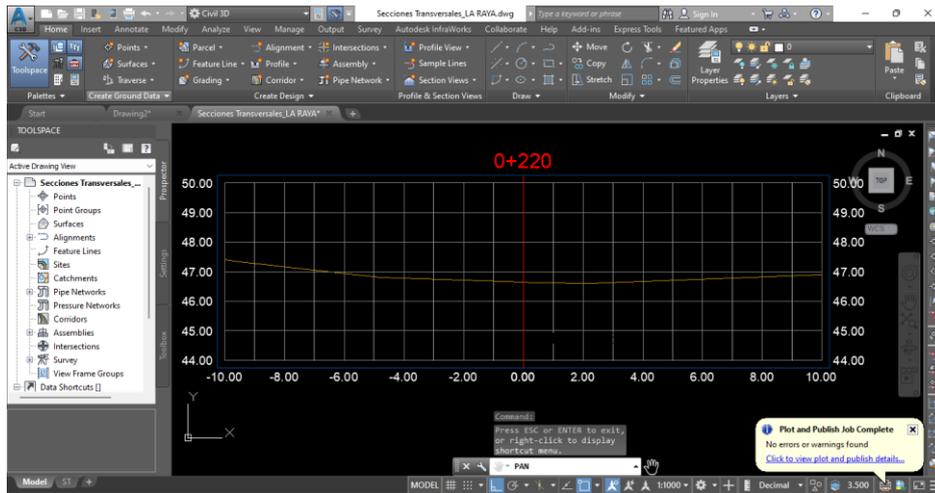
Trazo de Perfiles longitudinales y Secciones Transversales
